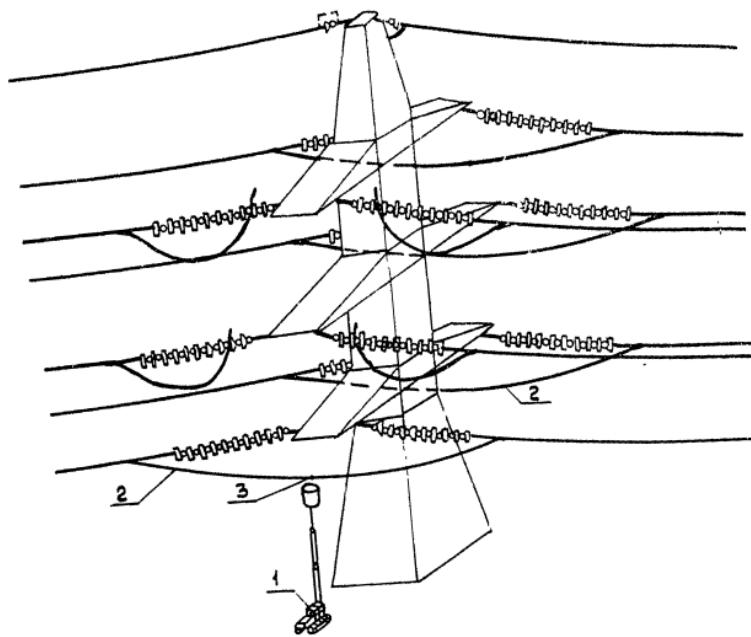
Монтаж петель шлейфа на анкерно-угловой опоре.
